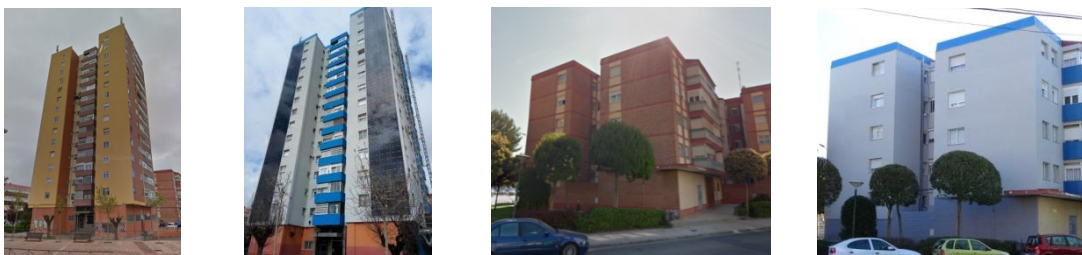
Aislamiento de fachadas y cubiertas (antes y después de la intervención)
